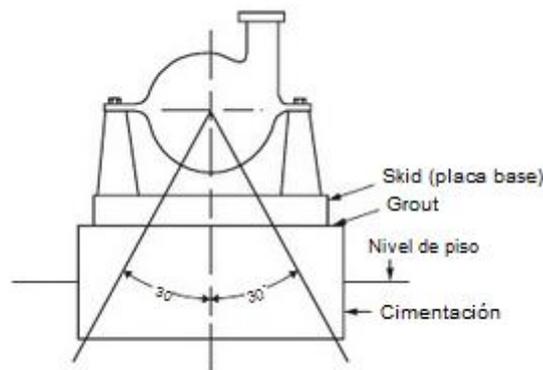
Dimensión preliminar de la altura de la cimentación. Fuente: “Plant Engineering Hand Book” de Mobley R. Keith
